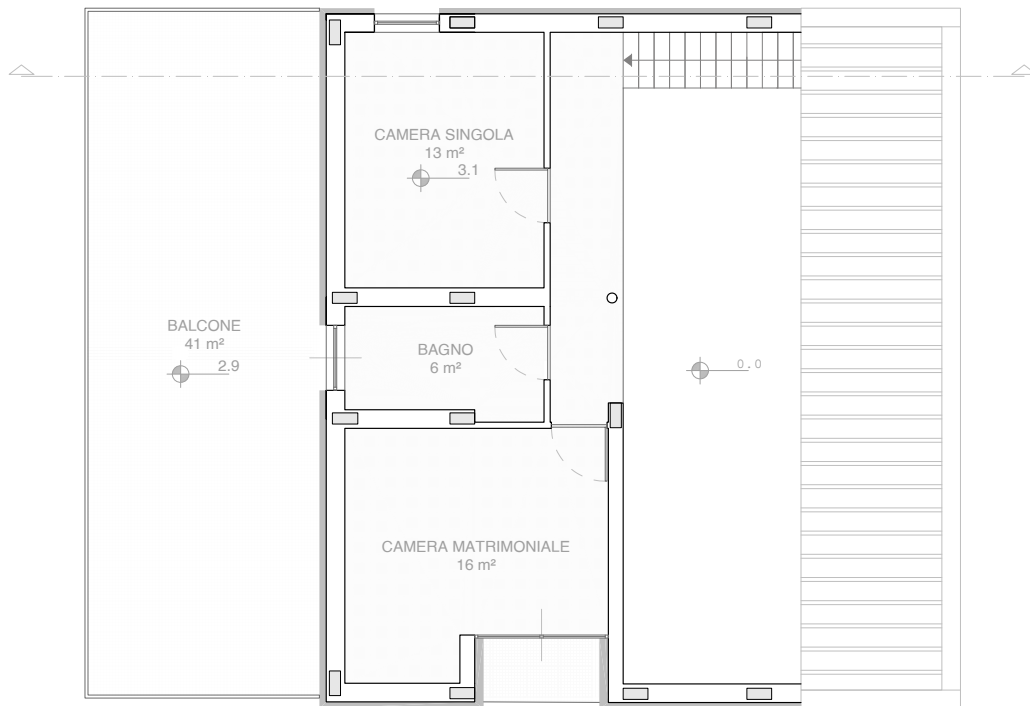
Restituzione da parte dell'autore della pianta della Biocasa Sarotto 2007 al piano primo
